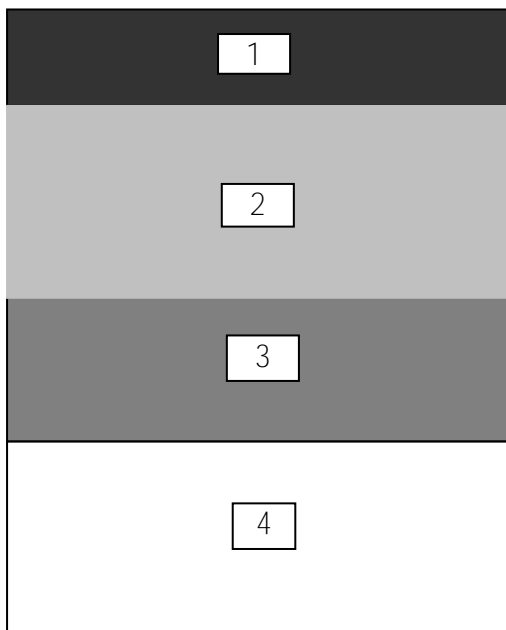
Конструкция дорожного покрытия с нижним слоем из цементобетона:
